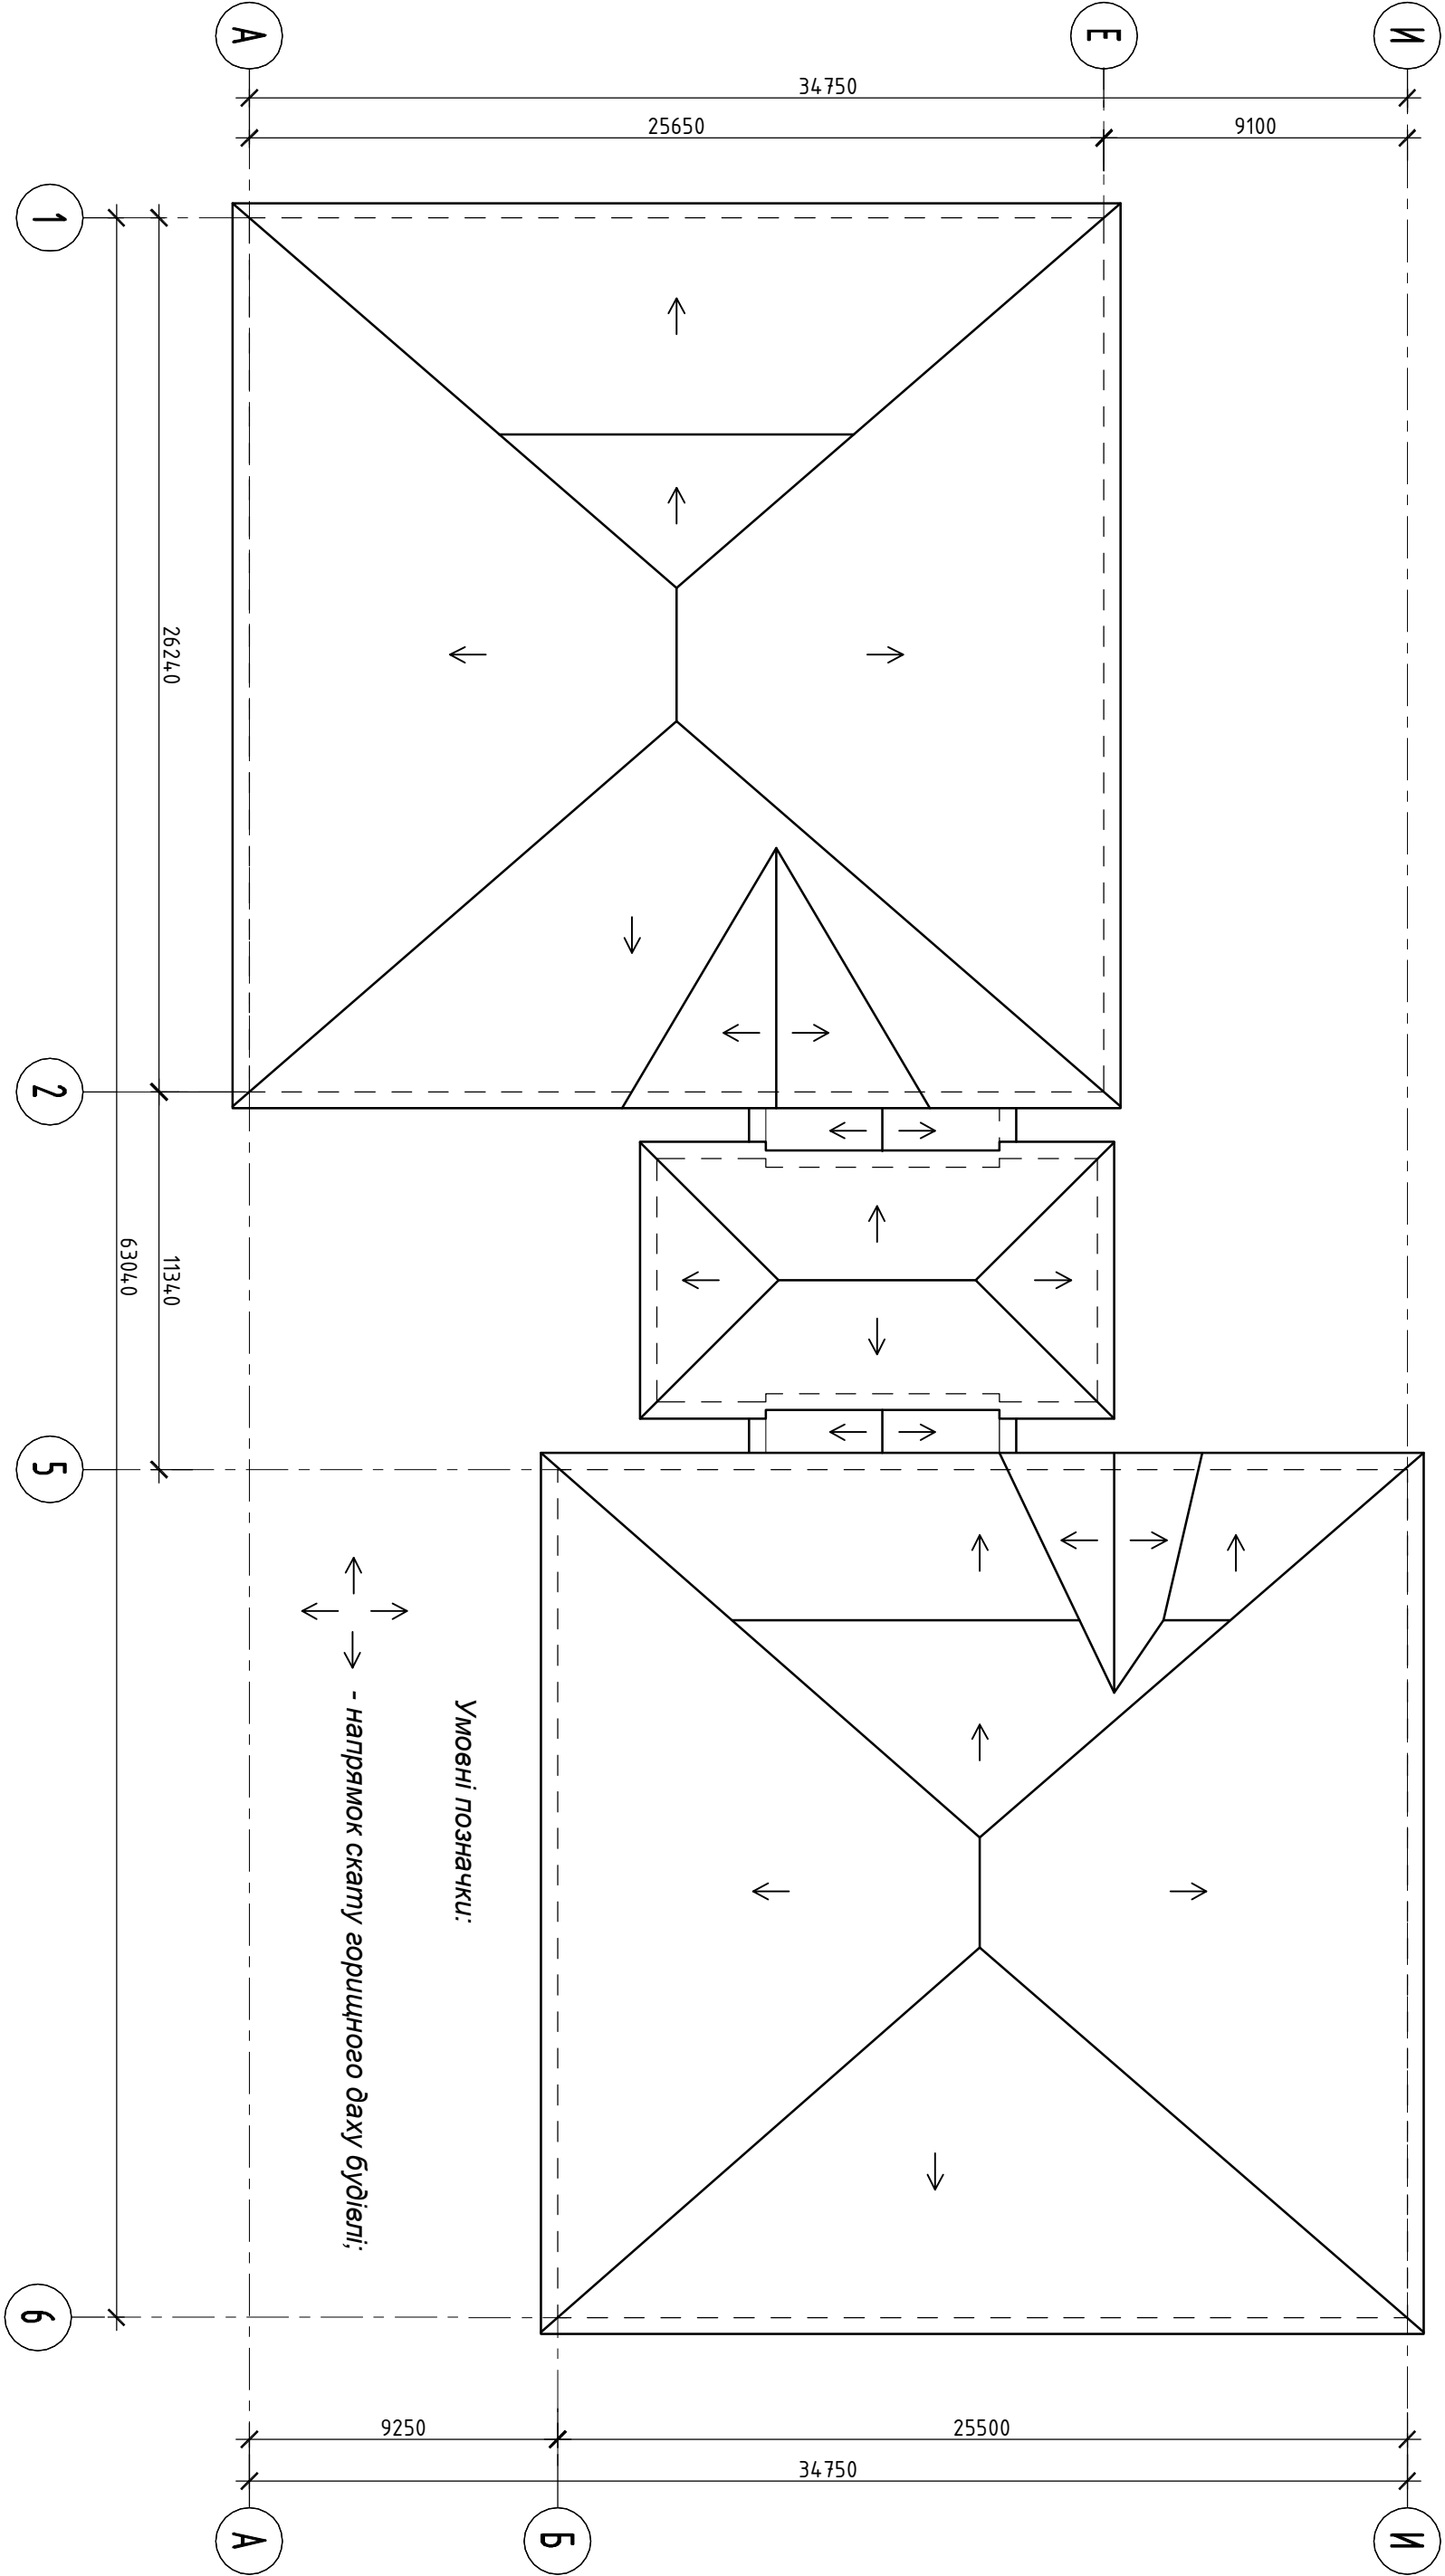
Габаритний план покрівлі будівлі.
